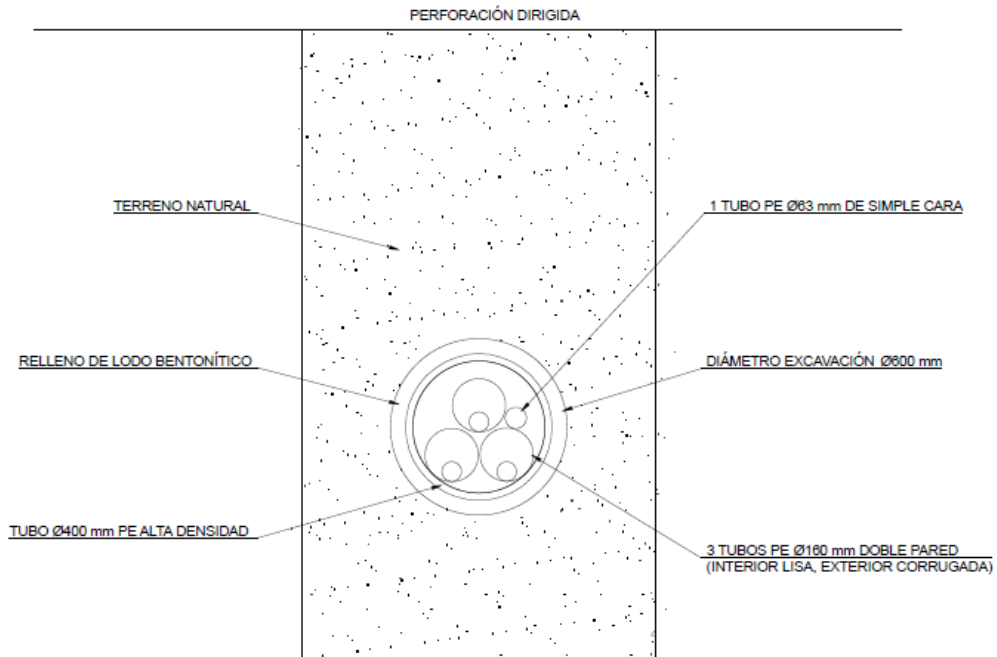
Zanja tipo - Trazado de línea subterránea 66 kV – Perforación Dirigida
